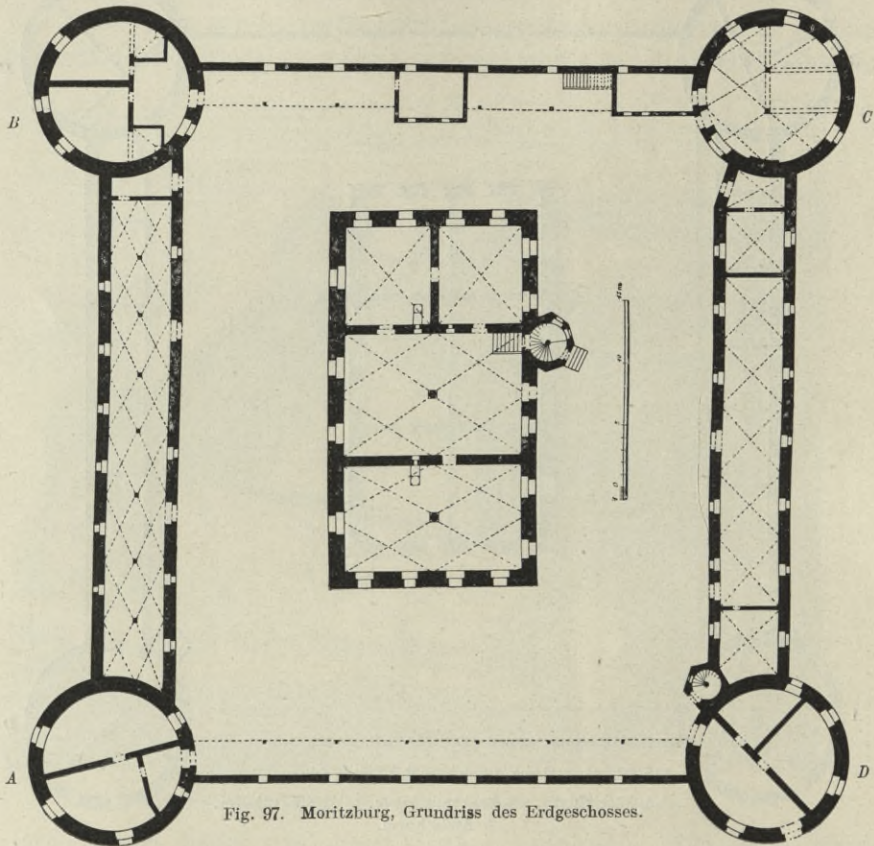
Moritzburg, Grundriss des Erdgeschosses.
